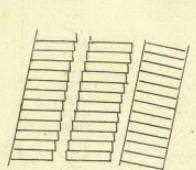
Кладка стѣнъ шпилей и башенъ: а) кладка горизонтальными рядами съ гладкой наружной поверхностью; б) же съ уступами съ той и другой стороны; в) кладка перпендикулярная къ поверхности шпилия.
